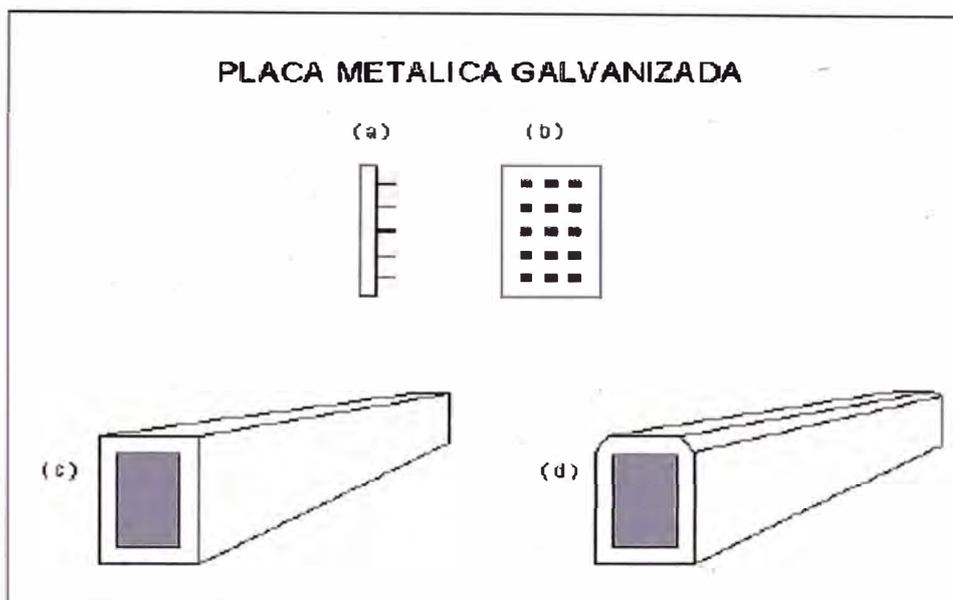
Placas anticuarteo secciones finales de la cruceta
